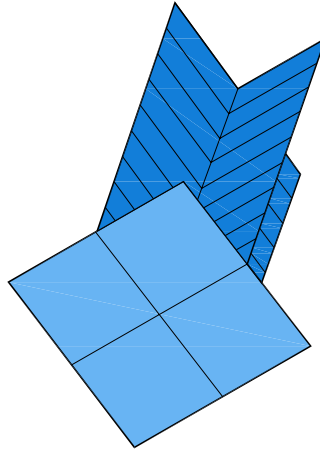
"Esquema de rigidización de apoyo utilizado."
